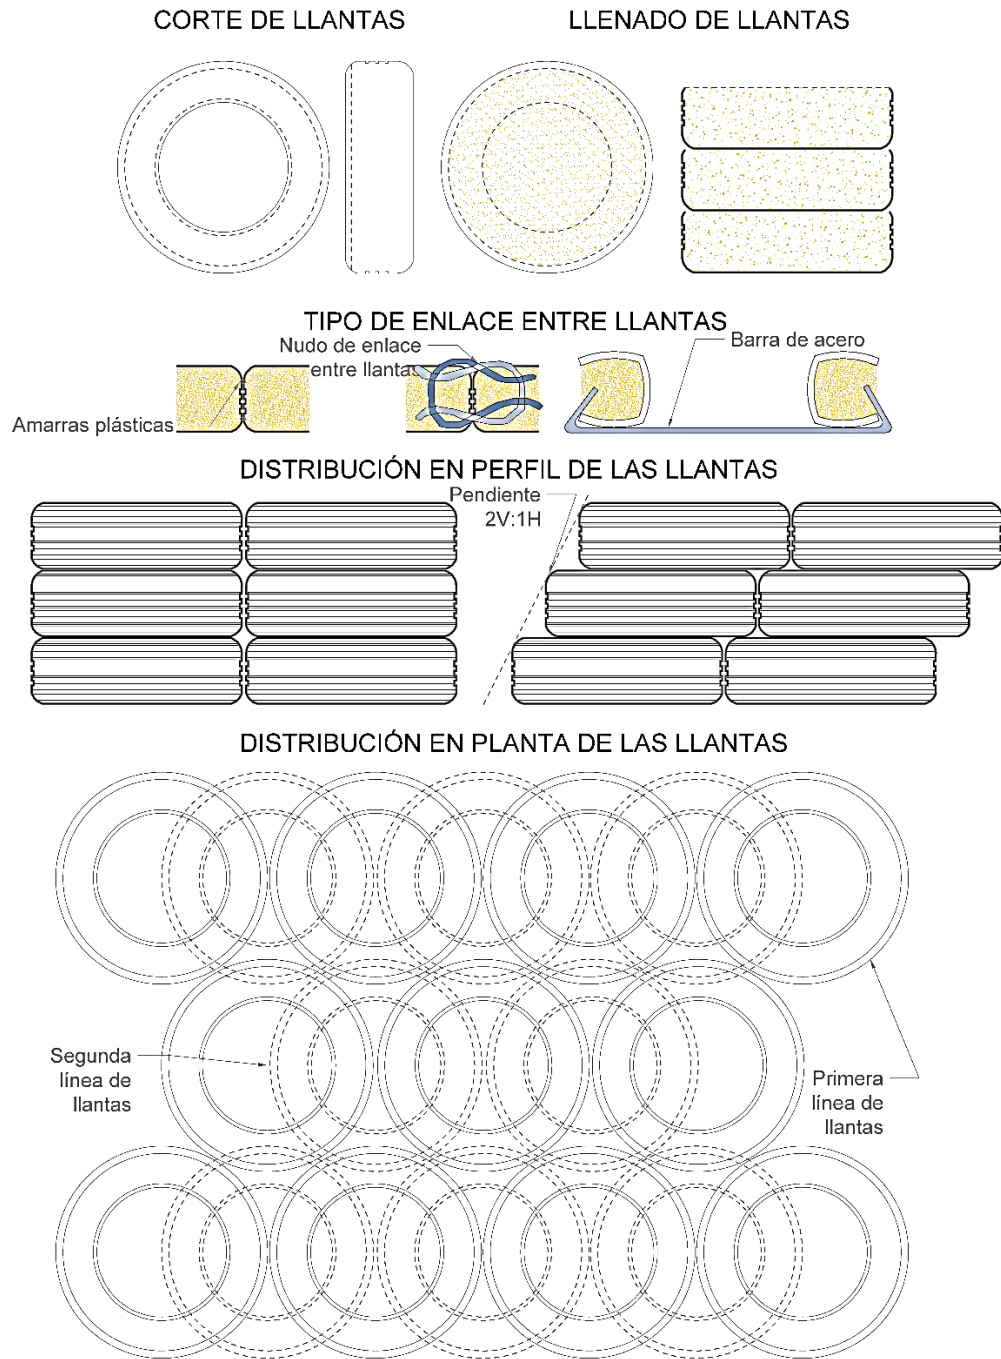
Detalles constructivos de los muros de contención con llantas.
